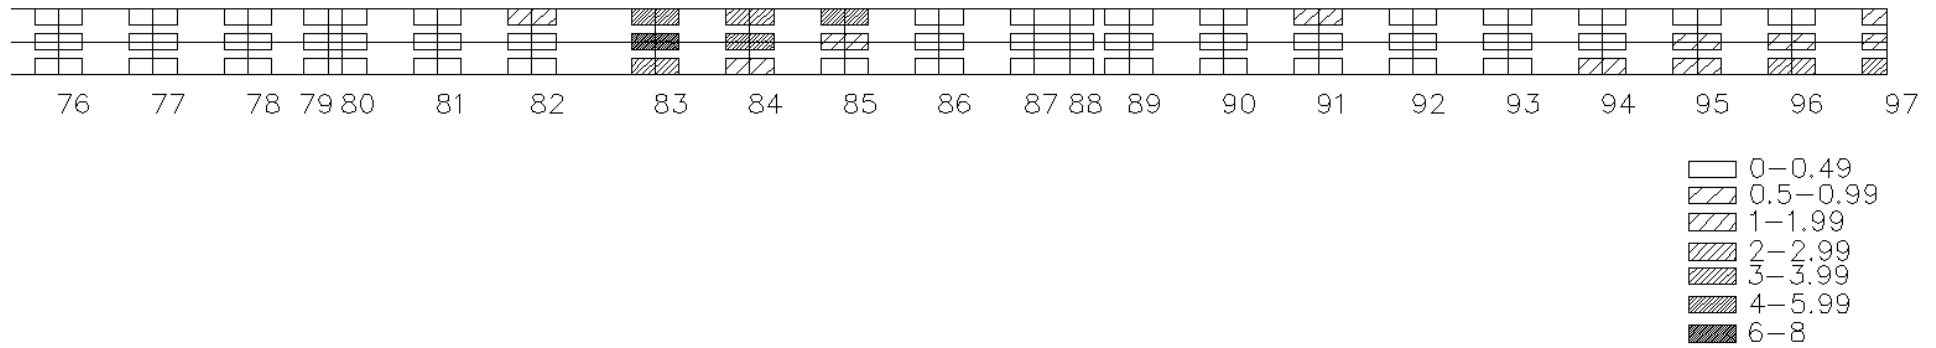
Frästiefen bei Tangenten und quadratischen Parabeln und Verfahrensplan Typ C, Grundriss, Stationen 76-97
